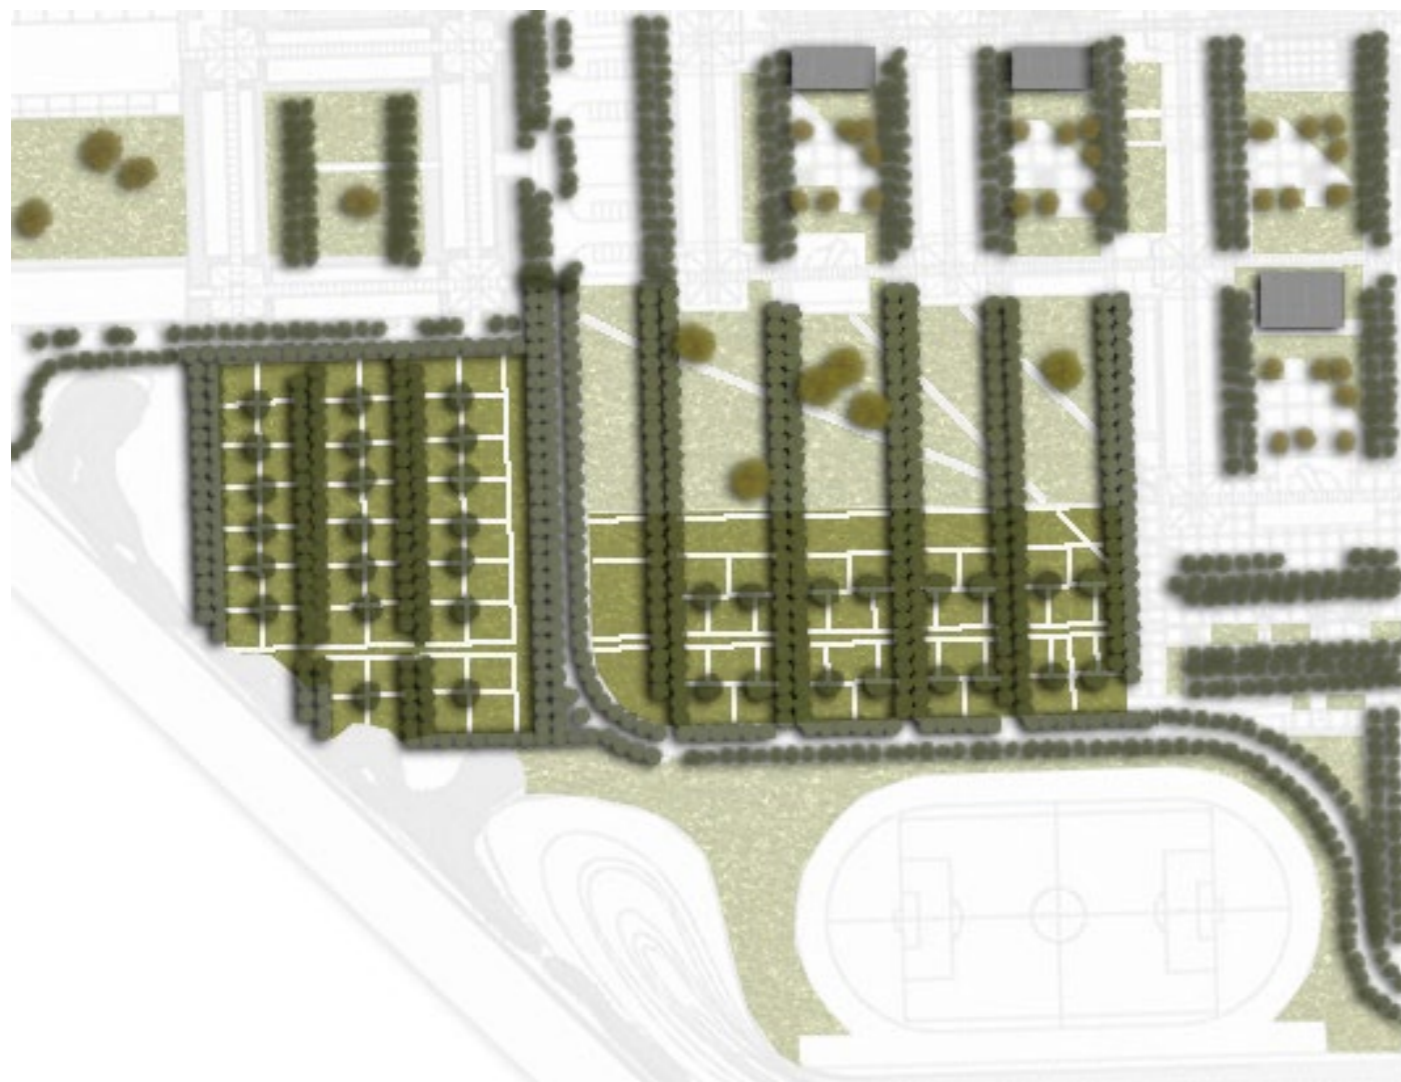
Rice Campus. Planta general. (Elaboración propia)
